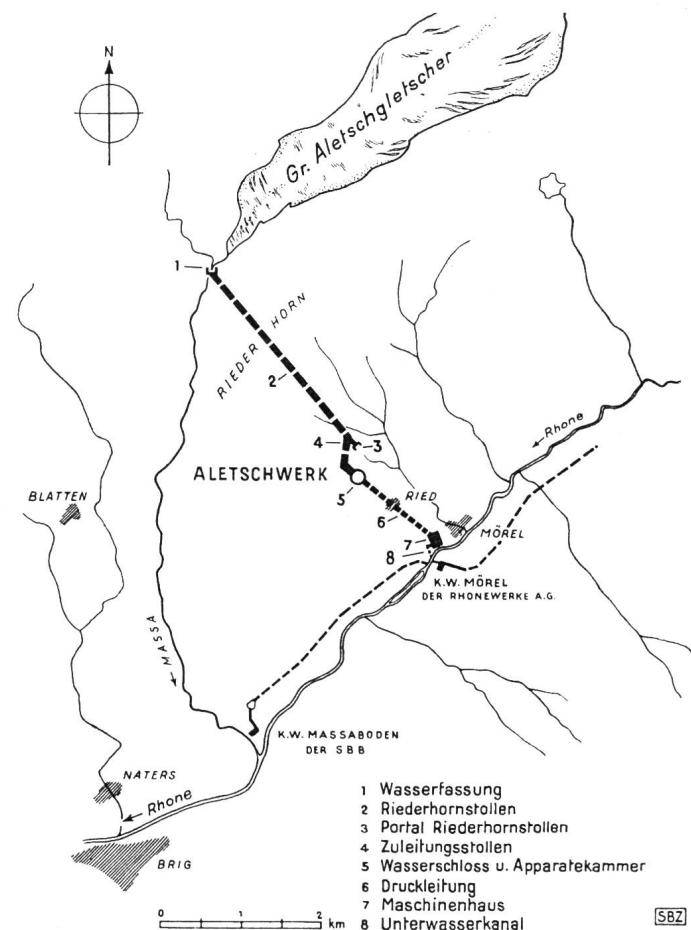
Aletschwerk, Lageplan 1 : 100 000 (Cliché SBZ)
